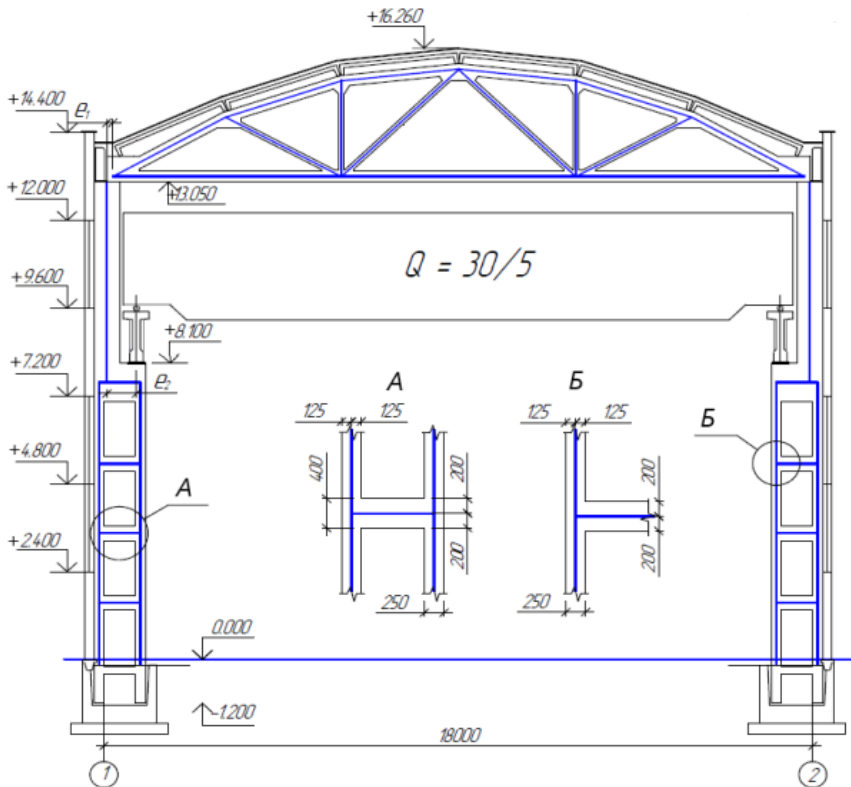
Приклад поперечного розрізу будівлі з нанесеною схемою каркасу
